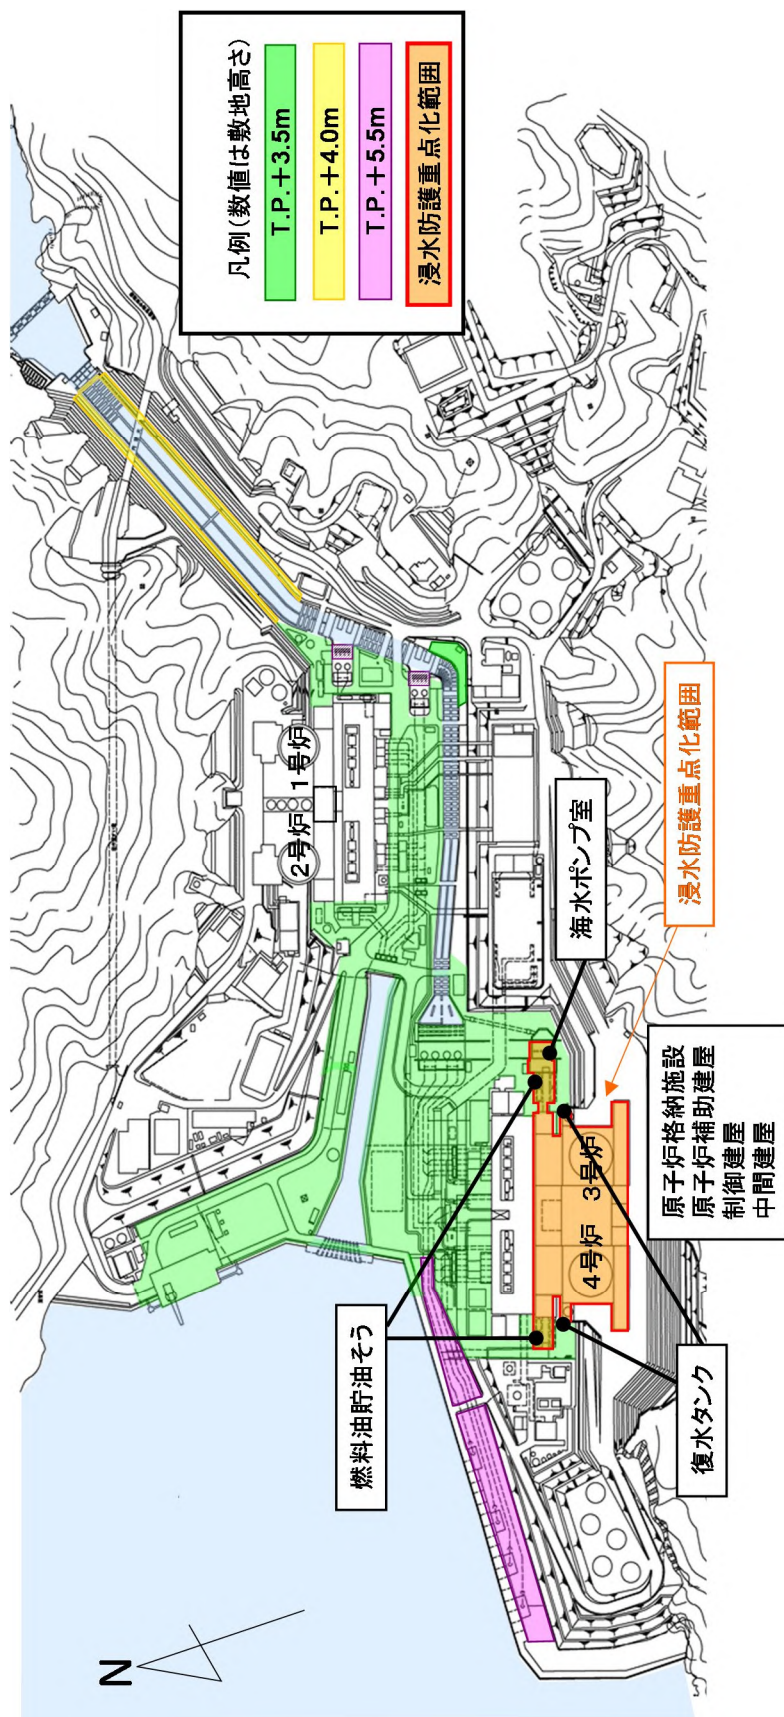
高浜発電所3号炉及び4号炉 全体配置図
